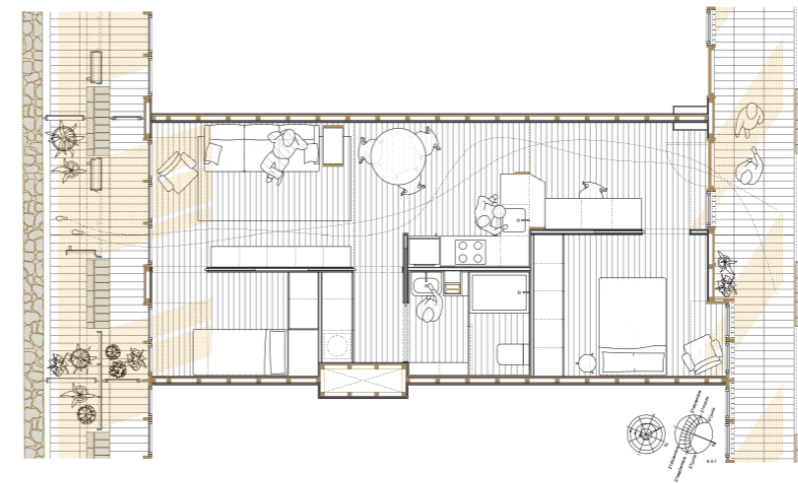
Planta tipo vivienda. Fuente: Roldán Berengué arqts / Jordi Surroca y Gael del Río.
